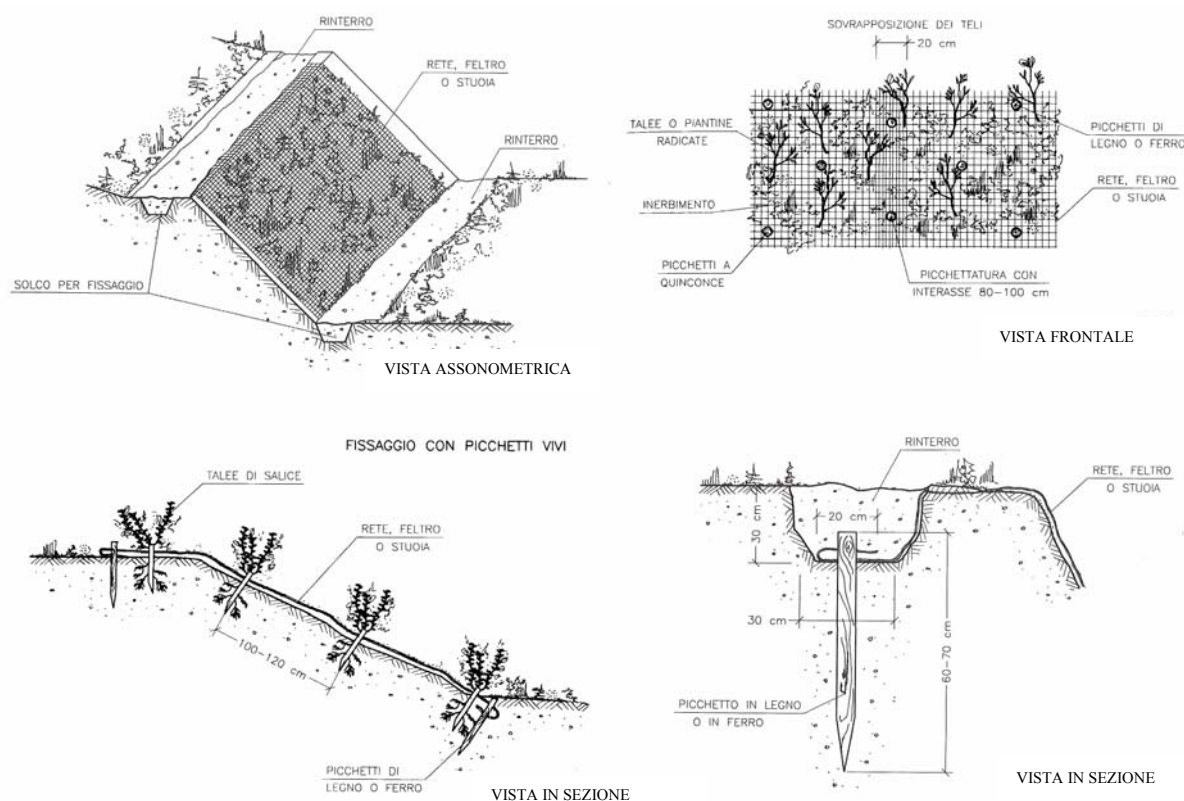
Viste esemplificative di un intervento di rivestimento; in basso a destra particolare del picchettamento di monte del rivestimento (da REGIONE LIGURIA, 1997) -
